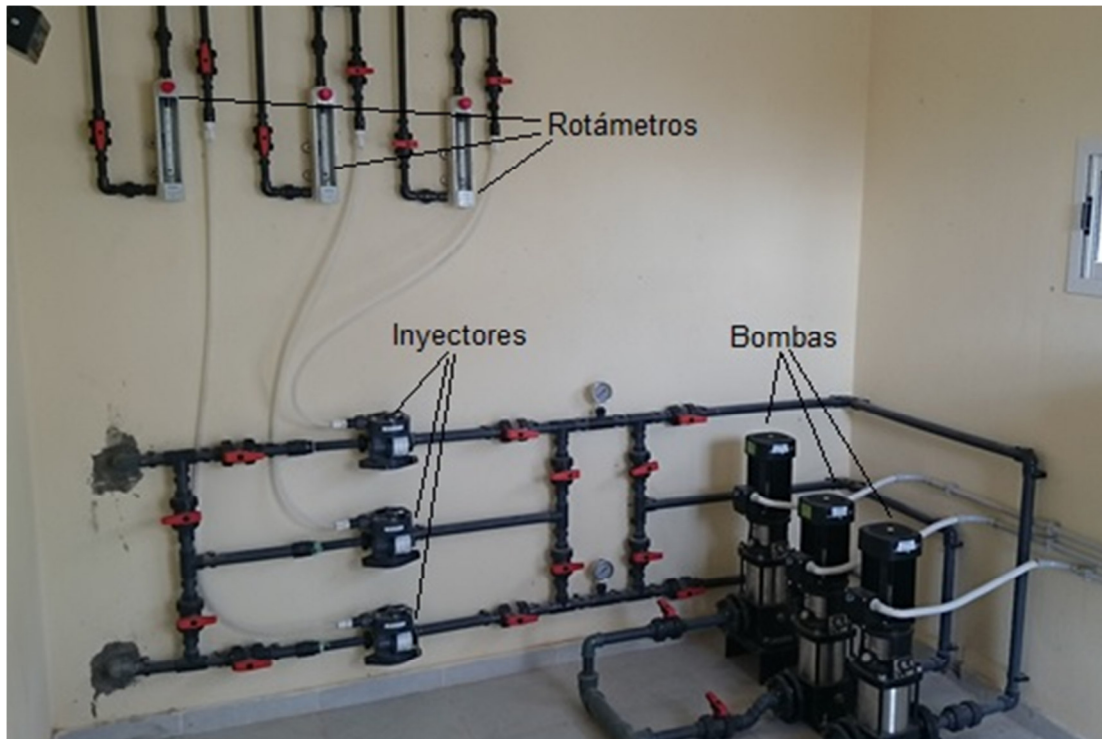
Batería de tubos conectada en paralelo estación de cloración
